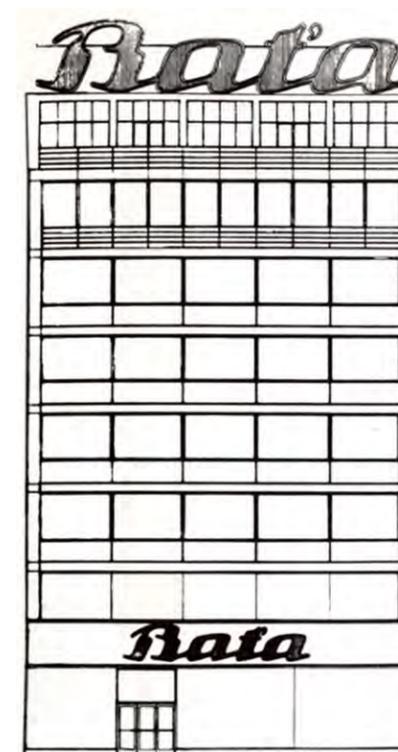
Alzado de la tienda de Praga, por Gahura y Kysela.
